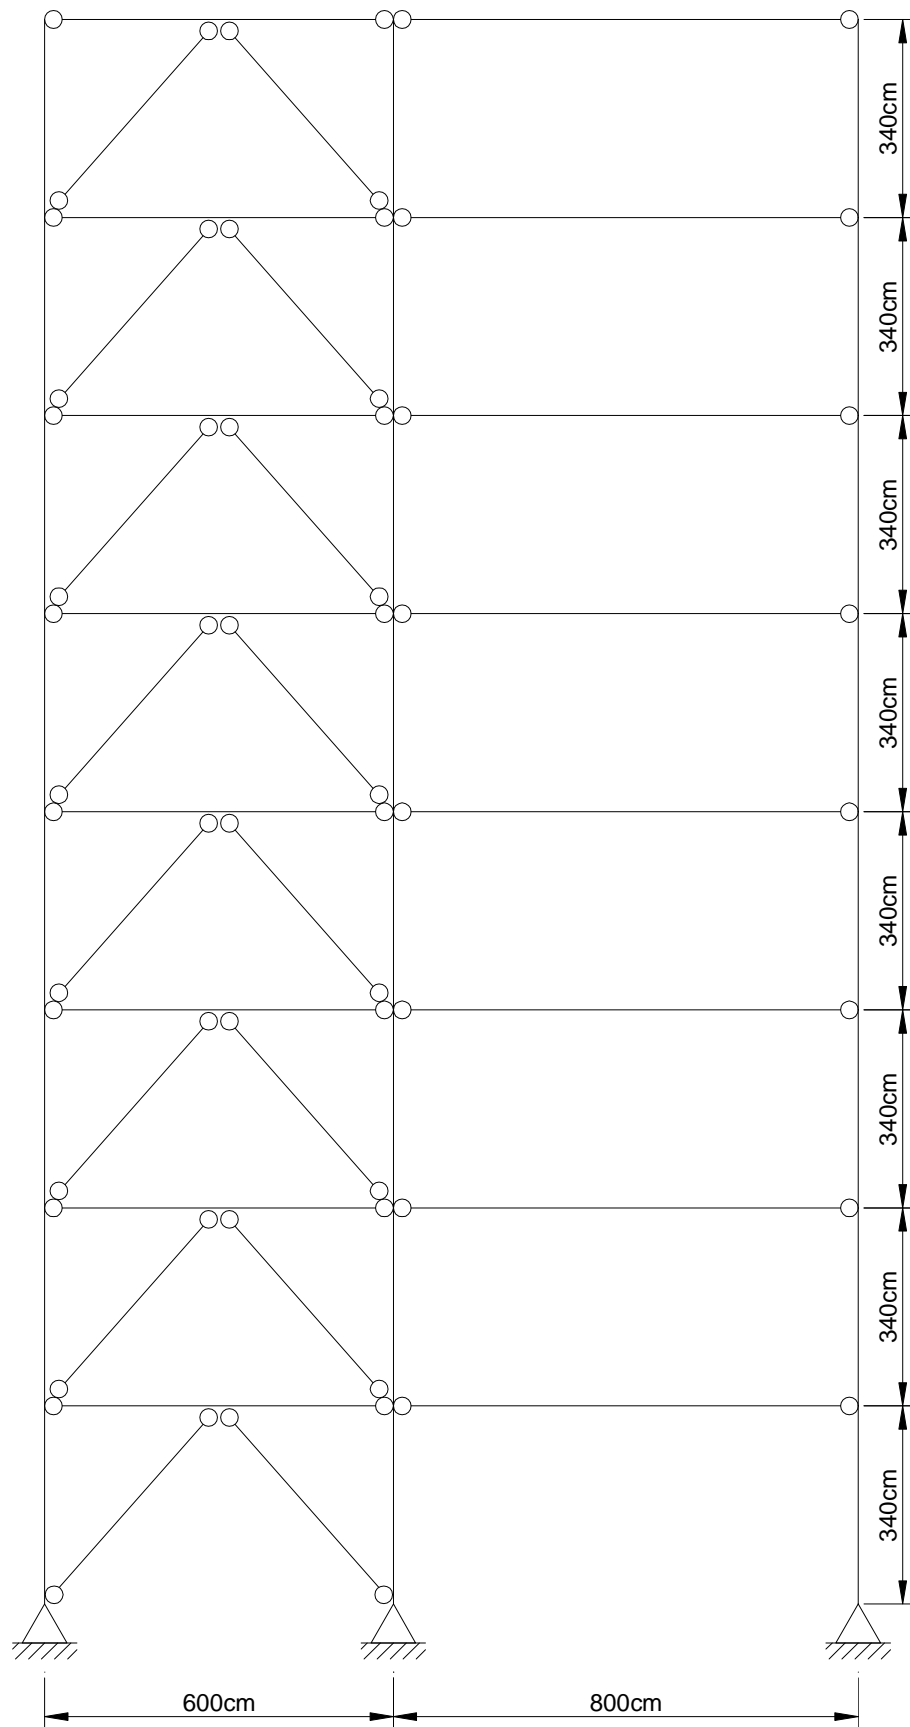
Tipologia utilizada no pórtico plano contraventado com barras de aço do caso A3.
